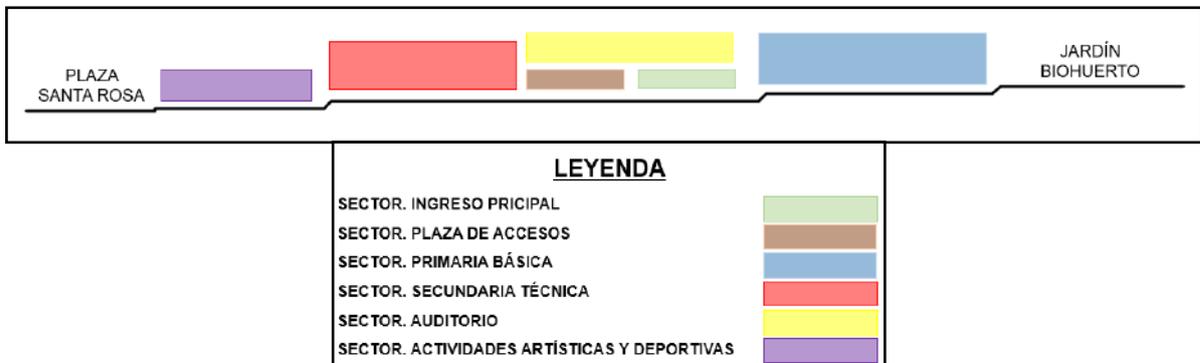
Sectorización. FUENTE: Elaboración propia
